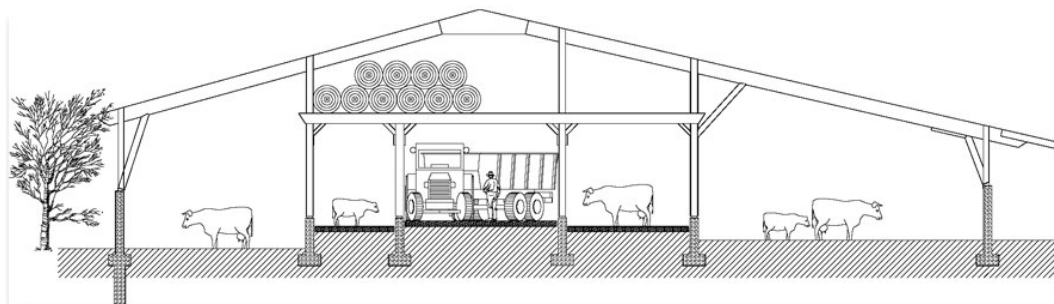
Coupe de principe d'un bâtiment Noétech pour bovins en stabulation libre sur aires paillées
